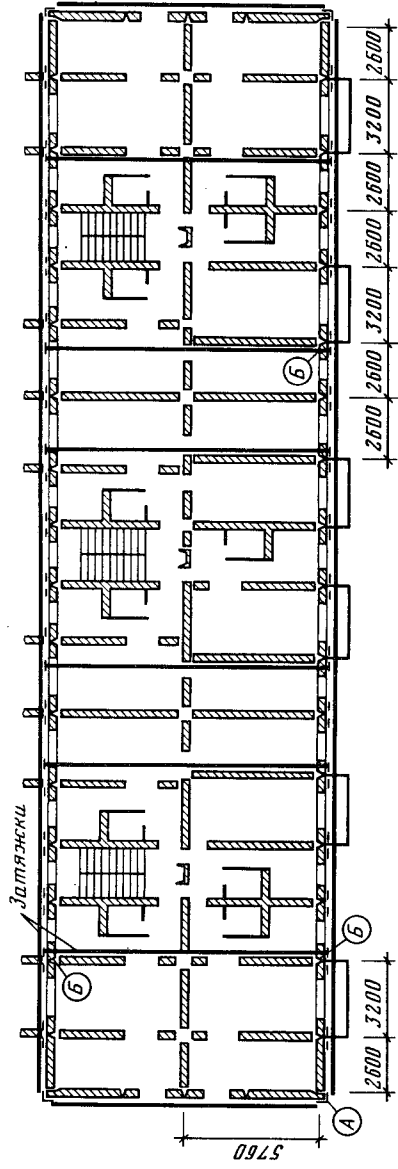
План типового этажа крупнопанельного здания в Гази
